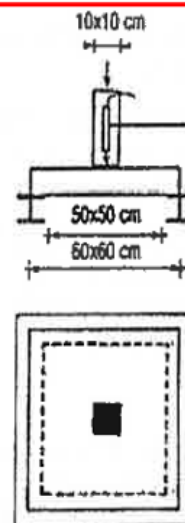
Essai de poinçonnement-flexion sur dalle.
